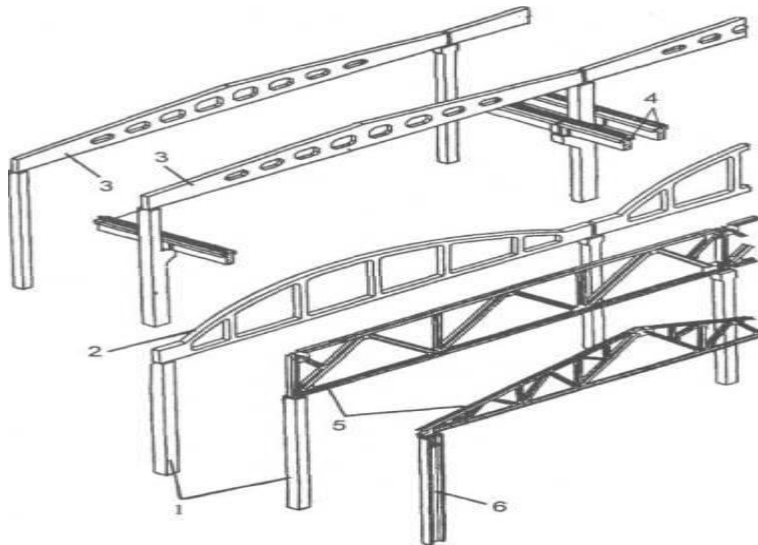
Залізобетонні та сталеві конструкції промислових будівель:
